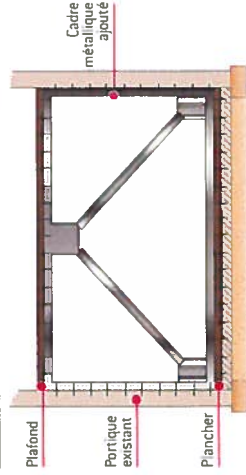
Exemple de renforcement du contreventement par ajout de croix type K ou Saint-André en charpente métallique ou en poutre de béton armé à un portique existant (coupe transversale)
